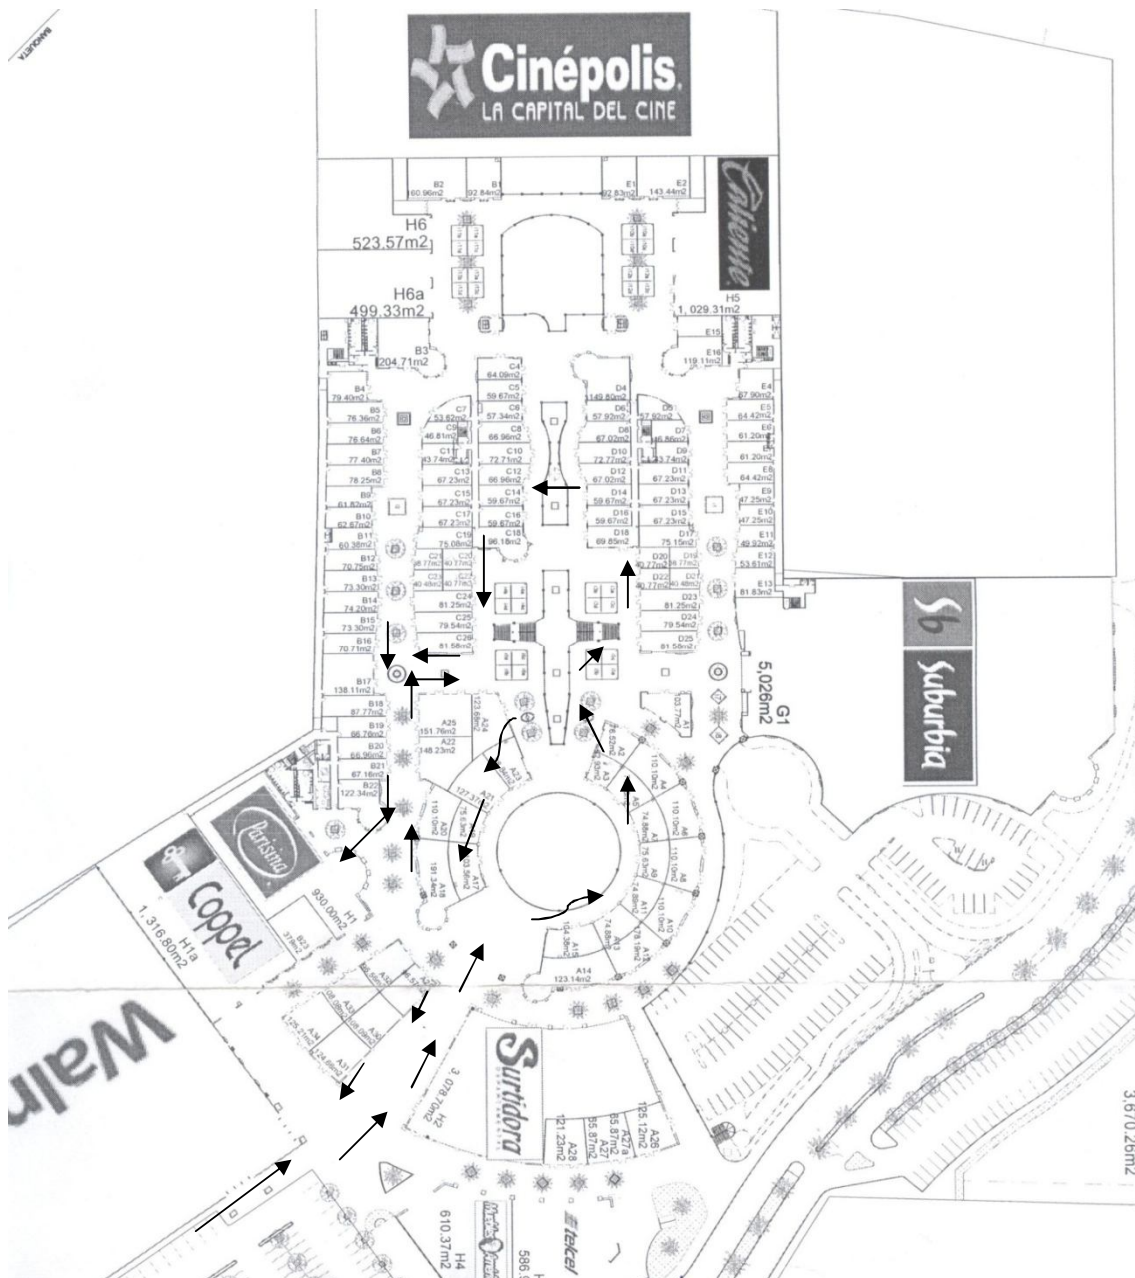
Flujo de personas en la planta baja de la Plaza Centro Sur.
